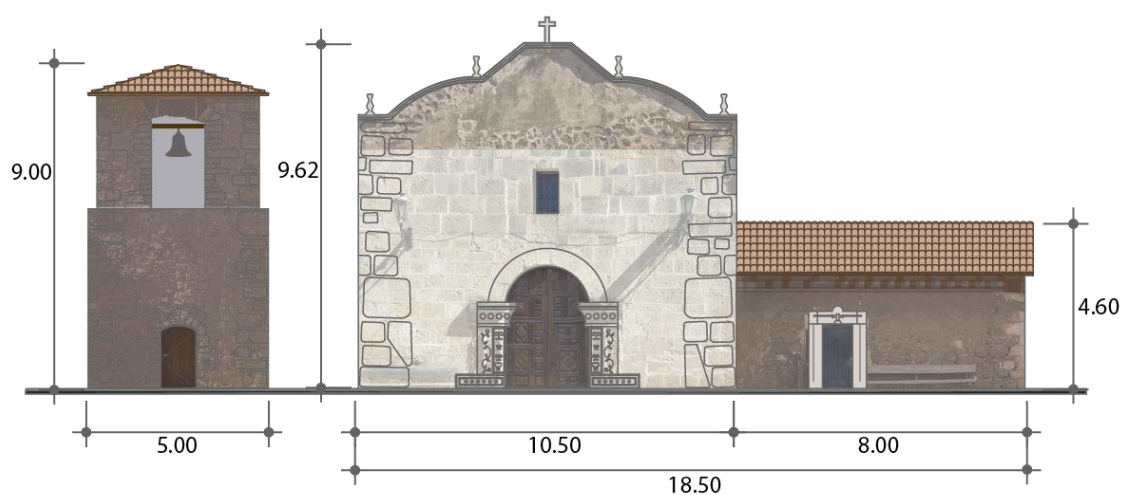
Alzado de etapa constructiva de finales del siglo XVIII. Elaboración propia.
